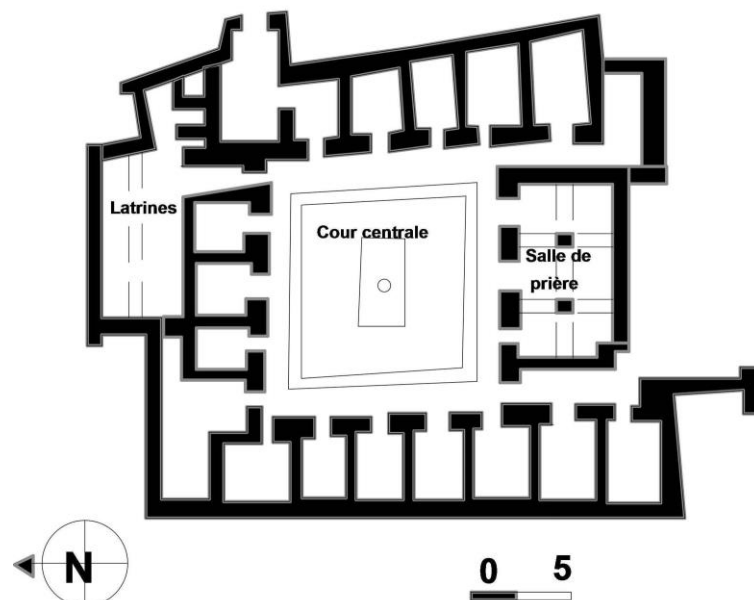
Vue en plan du rez-de-chaussée de la medersa d'el-Nakhla
